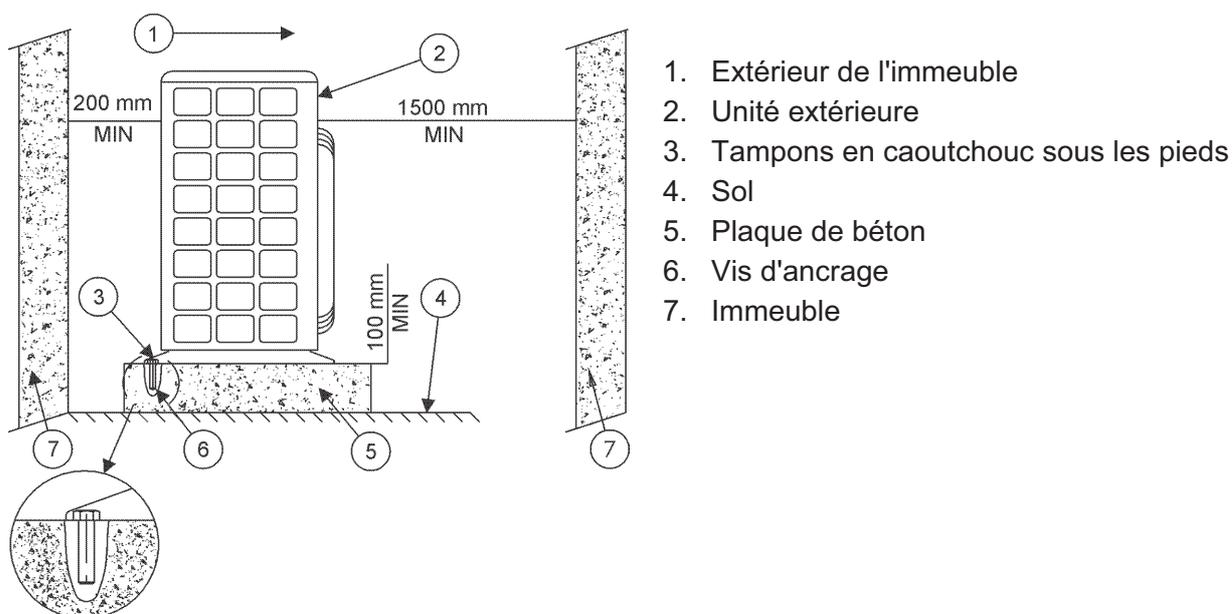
Installation de l'unité extérieure sur une plaque de béton
